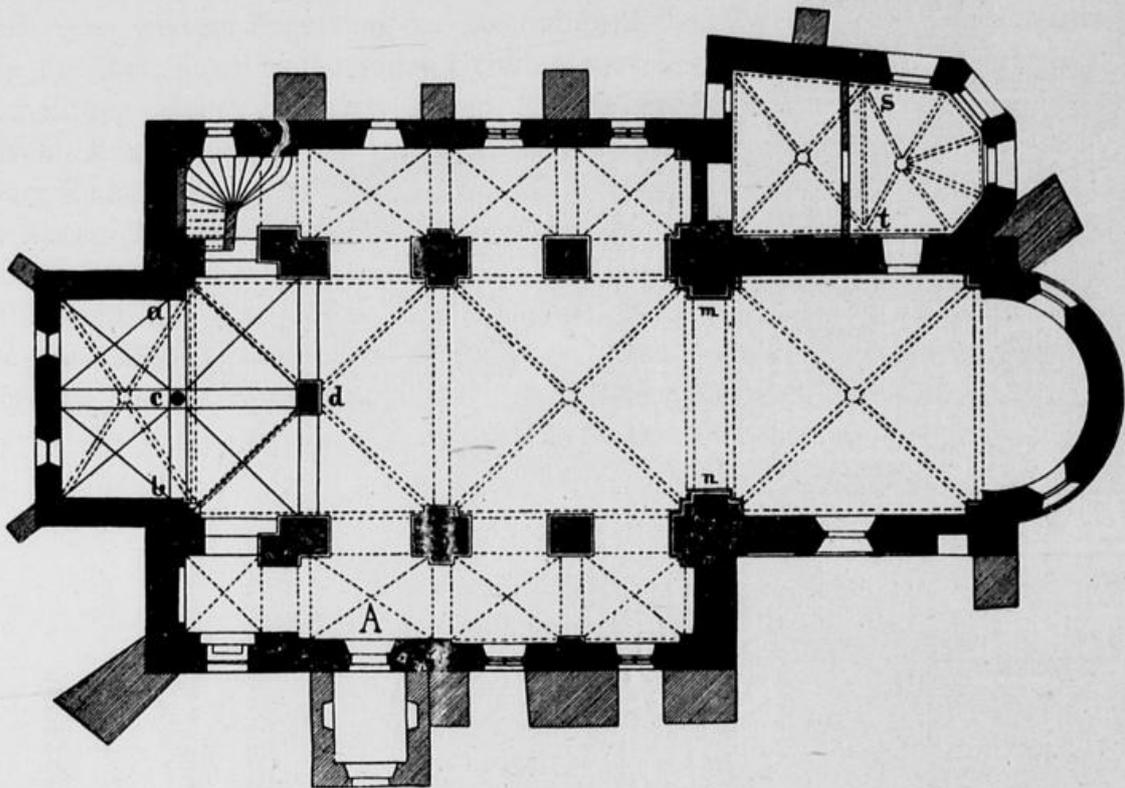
Stoppenberg, alte kath. Pfarrkirche. Grundriss.
